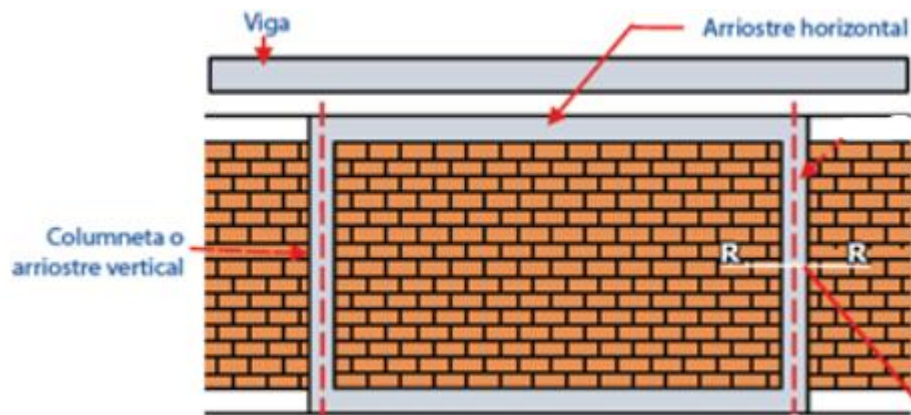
Mampostería de muros confinados. Adaptado de *Concretos Presforzados de Servicio Nacional de Aprendizaje (2011)*.
